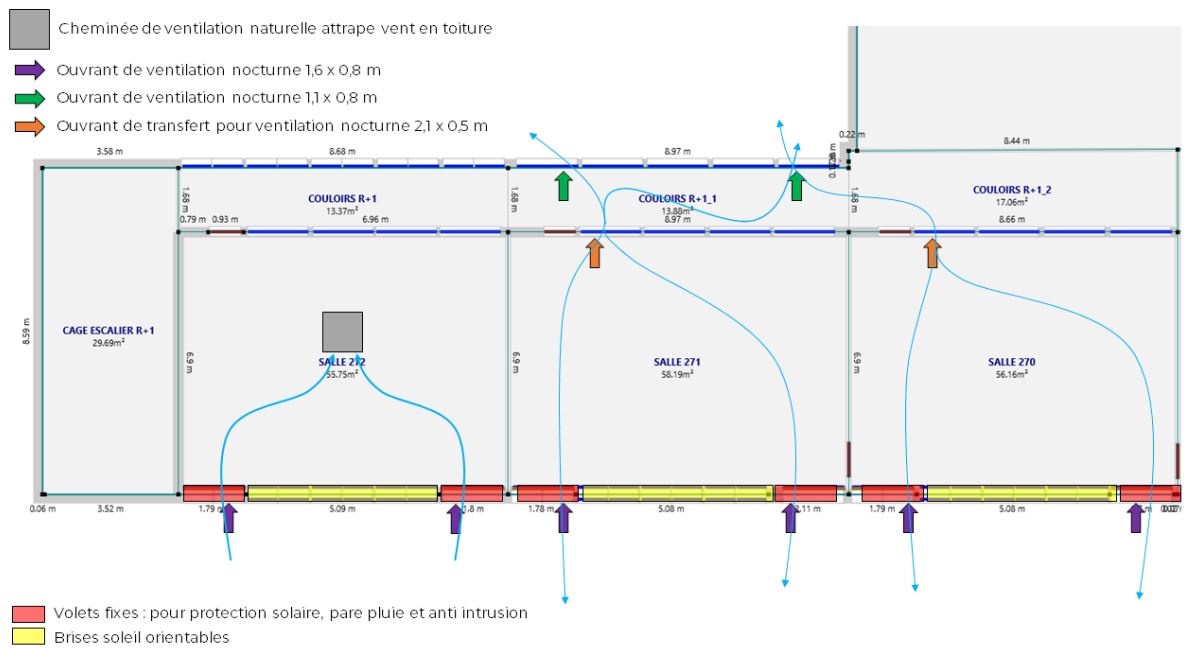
plan de repérage protections solaires extérieures et surventilation nocturne du R+1
